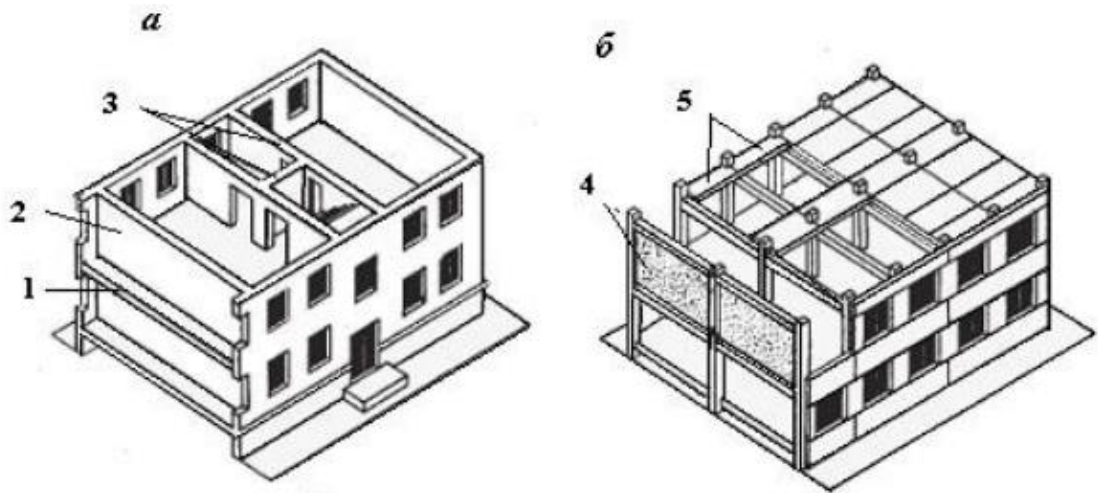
Конструктивні елементи, які забезпечують просторову жорсткість будівлі: а – безкаркасної; б – каркасної; 1 – міжповерхове перекриття; 2 – поперечна стіна; 3 – стіни сходової клітки; 4 – стінки жорсткості; 5 – плити розпірки
